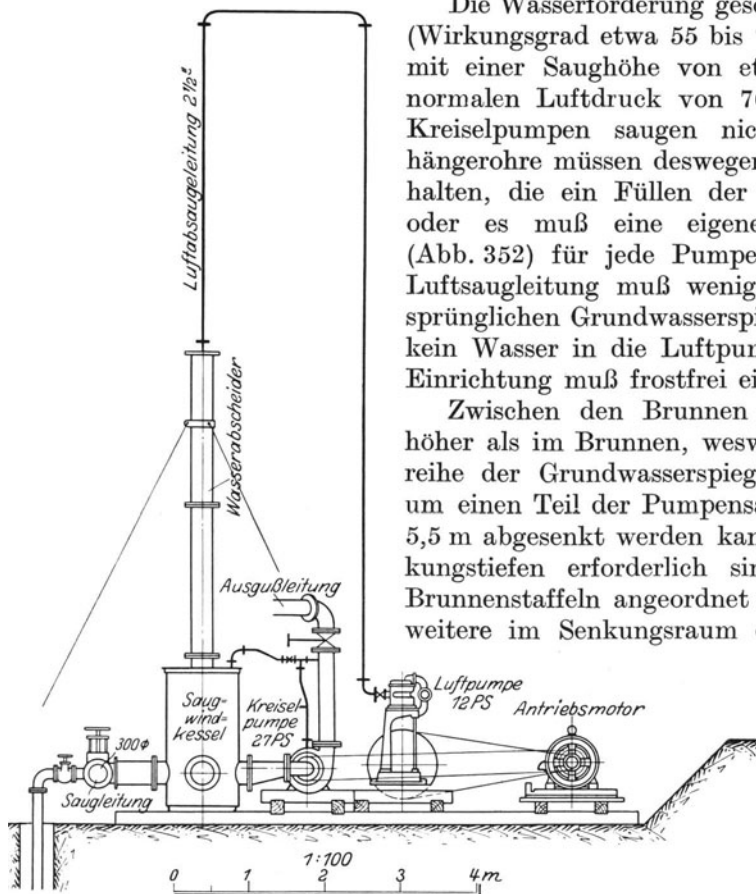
Entlüftungseinrichtung für eine Grundwassersenkungsanlage. (Aus G. Hetzel u. O. Wundram. Die Grundbautechnik und ihre maschinellen Hilfsmittel. Berlin: Julius Springer.)
